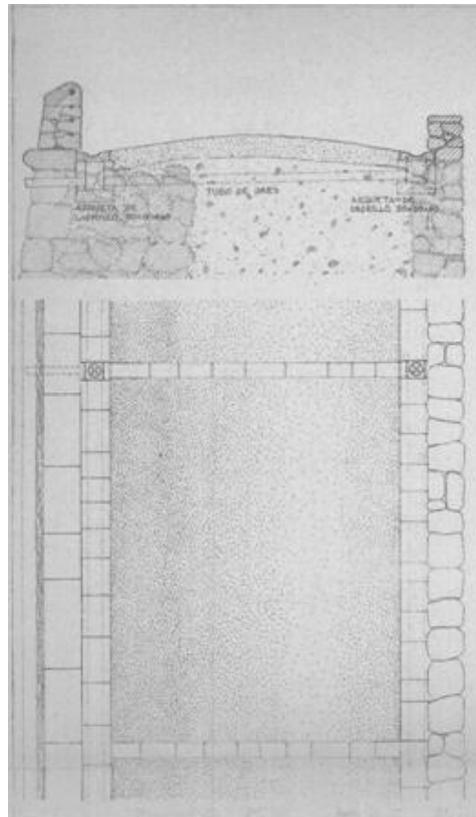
Javier Vellés, proyecto de 1980, detalle constructivo.
